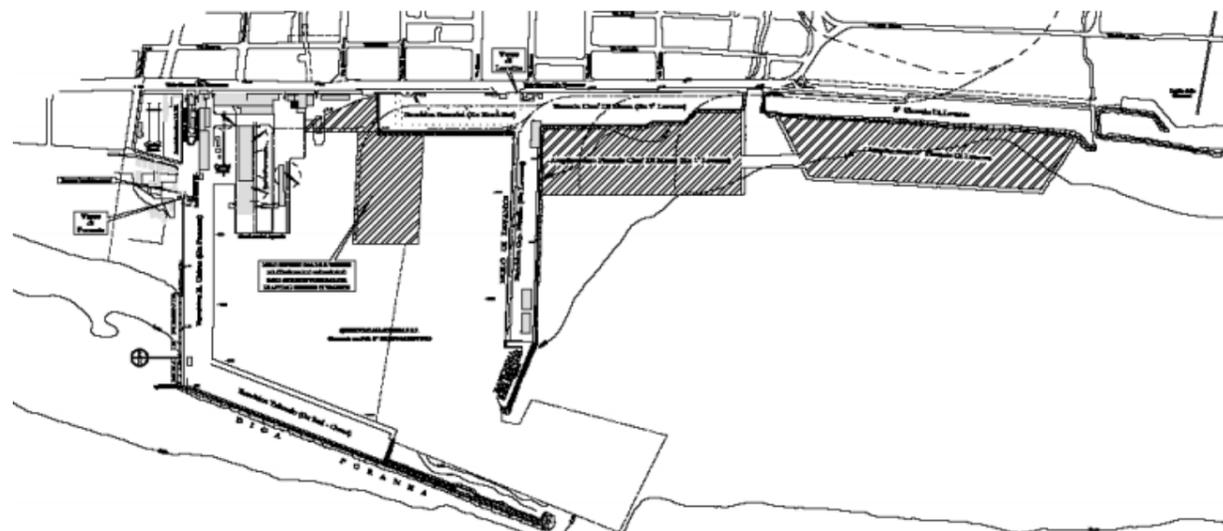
Planimetria del PRP del 1981 (AdSP)
